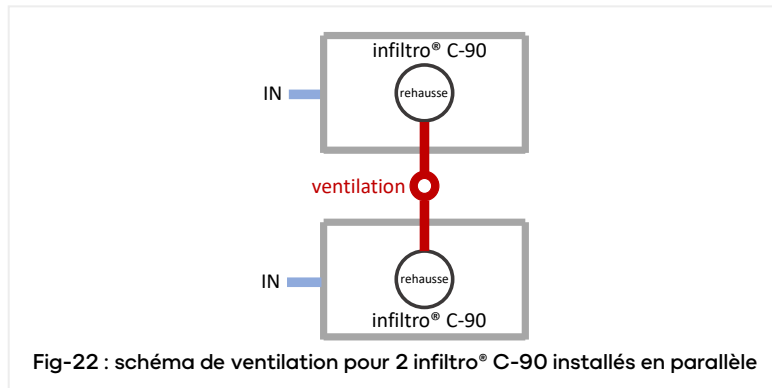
schéma de ventilation pour 2 infiltro® C-90 installés en parallèle
